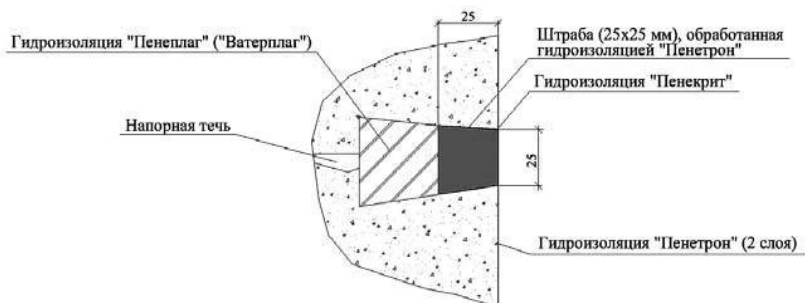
Гидроизоляция конструкции по штукатурке кирпича
